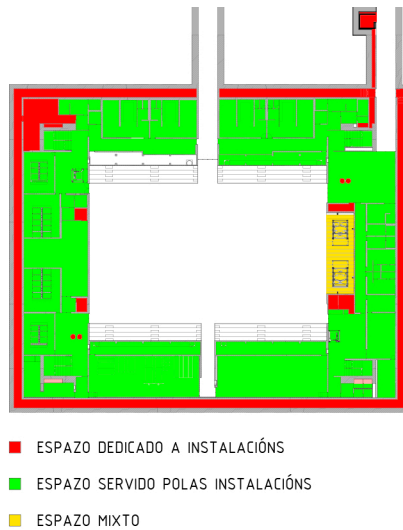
Esquema de ocupación das instalacións na planta baixo chan.
